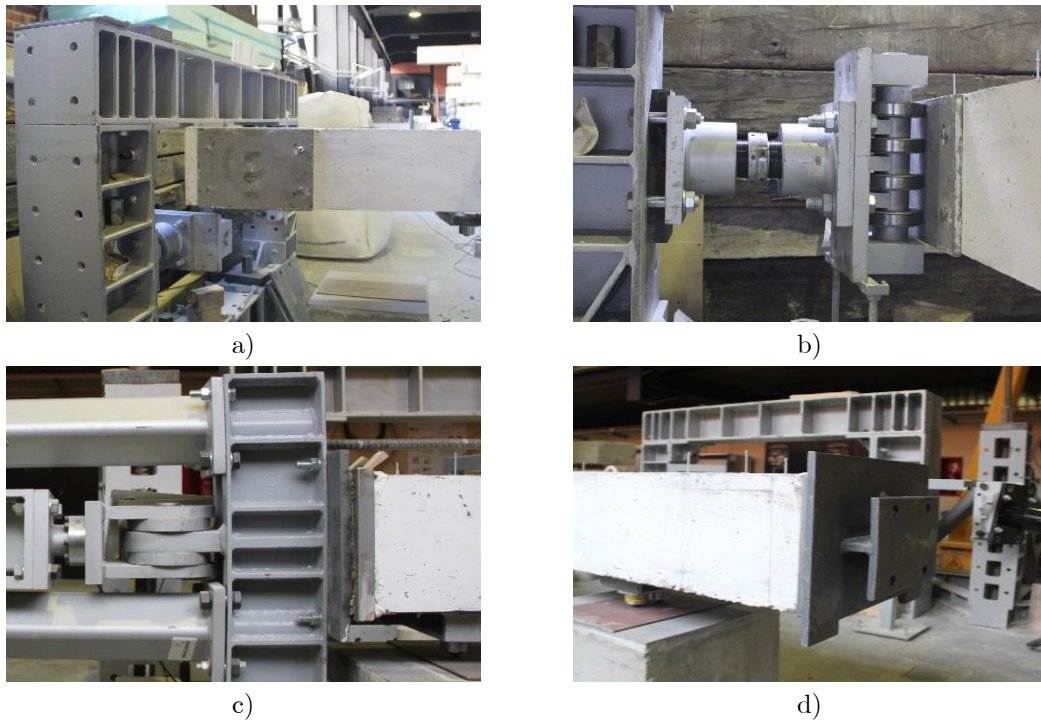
Preparação do provete: a) Capa metálica afixada nas extremidades da viga; b) Pormenor da chapa em contacto com o slide; c) Peça metálica na base do pilar inferior; d) Peça metálica no topo do pilar superior.
